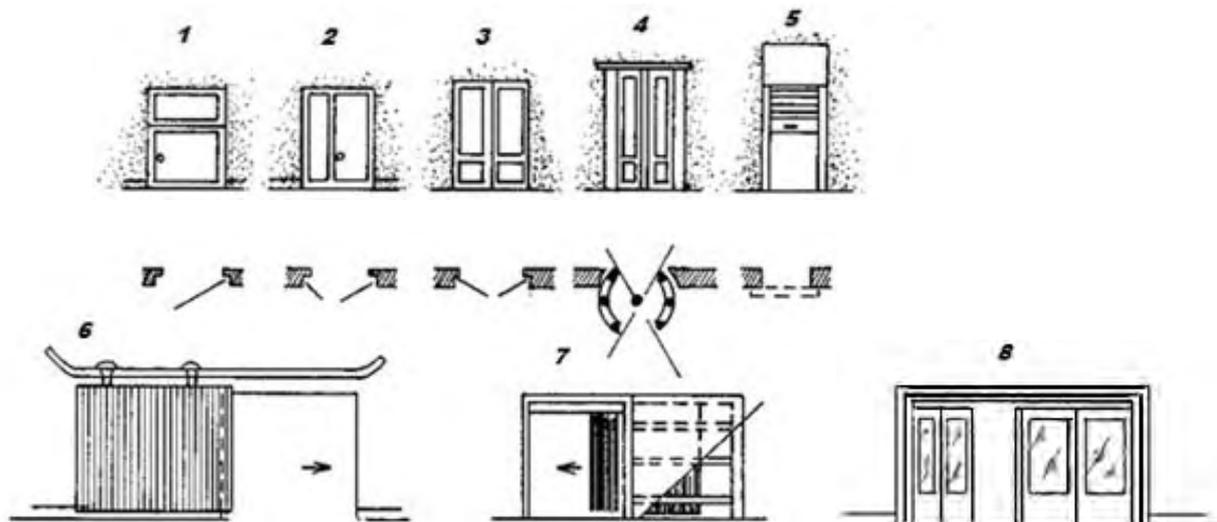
Виды дверей: 1—3 распашные (1 — однополюная; 2 — полуторная; 3 — двуполюная); 4 — вращающаяся дверь — турникет; 5 — подъемная шторная; 6 — откатная; 7 — прямораздвижная; 8 — шарнирно-складывающаяся
